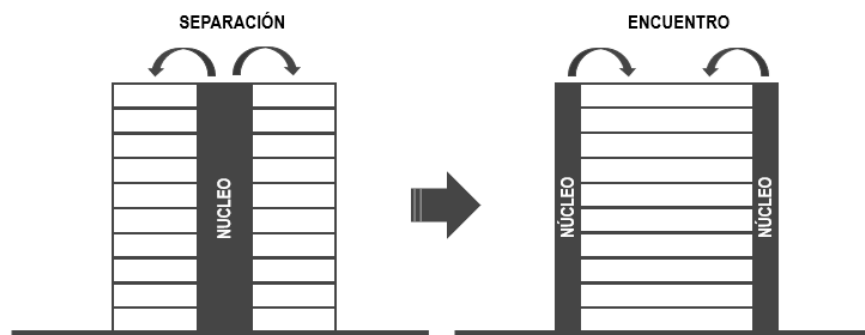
Sección esquemática del “Centro de Innovación UC.”
